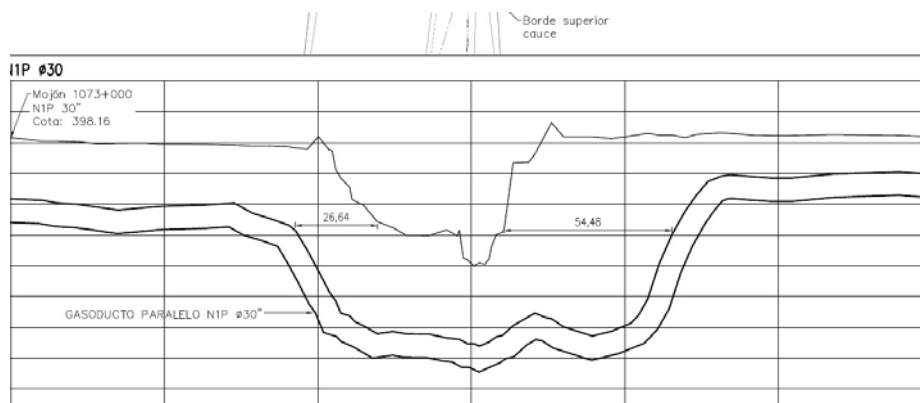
Tapadas horizontales medidas en el plano de corte longitudinal
